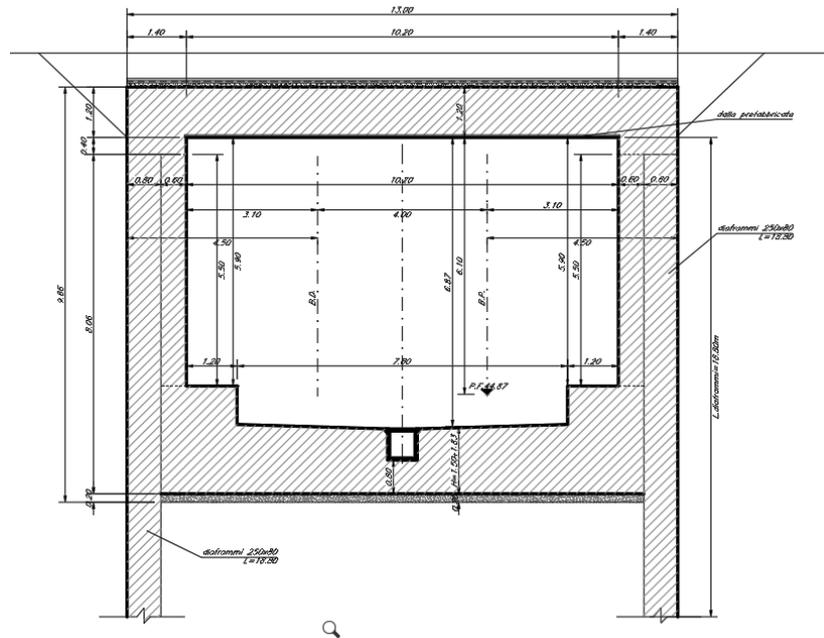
Sezione trasversale galleria artificiale a diaframmi con metodo Milano
